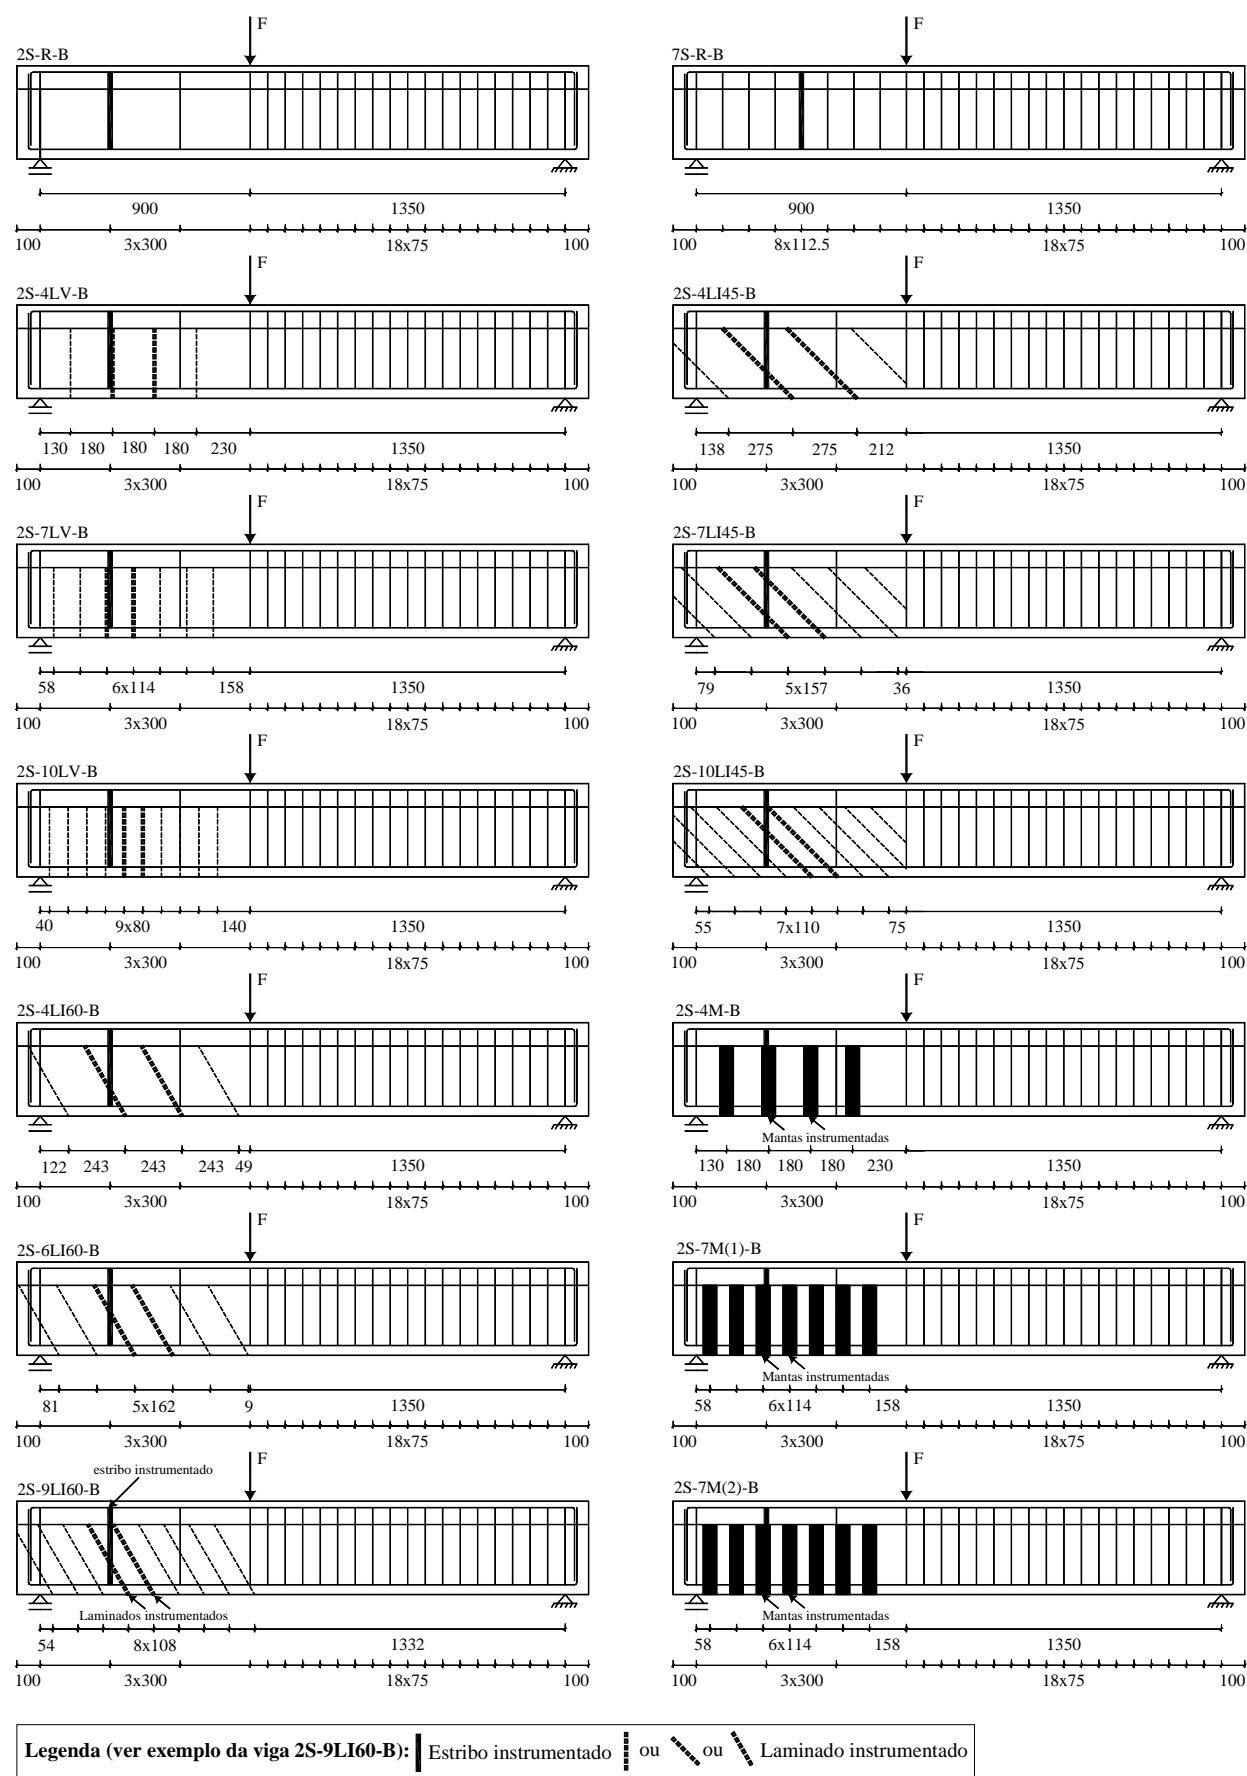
Localização dos estribos e laminados instrumentados nas vigas da série B com $\rho_{sw} = 0.10\%$ e na viga 7S-R-B.
